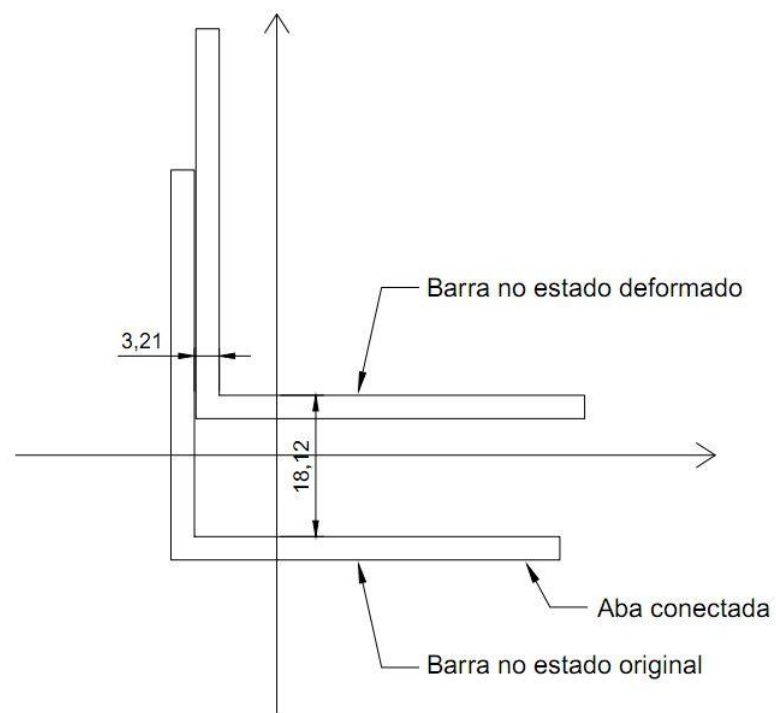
Cantoneira no estado original estado deformado para esbelteza 120. Fonte: O autor.
